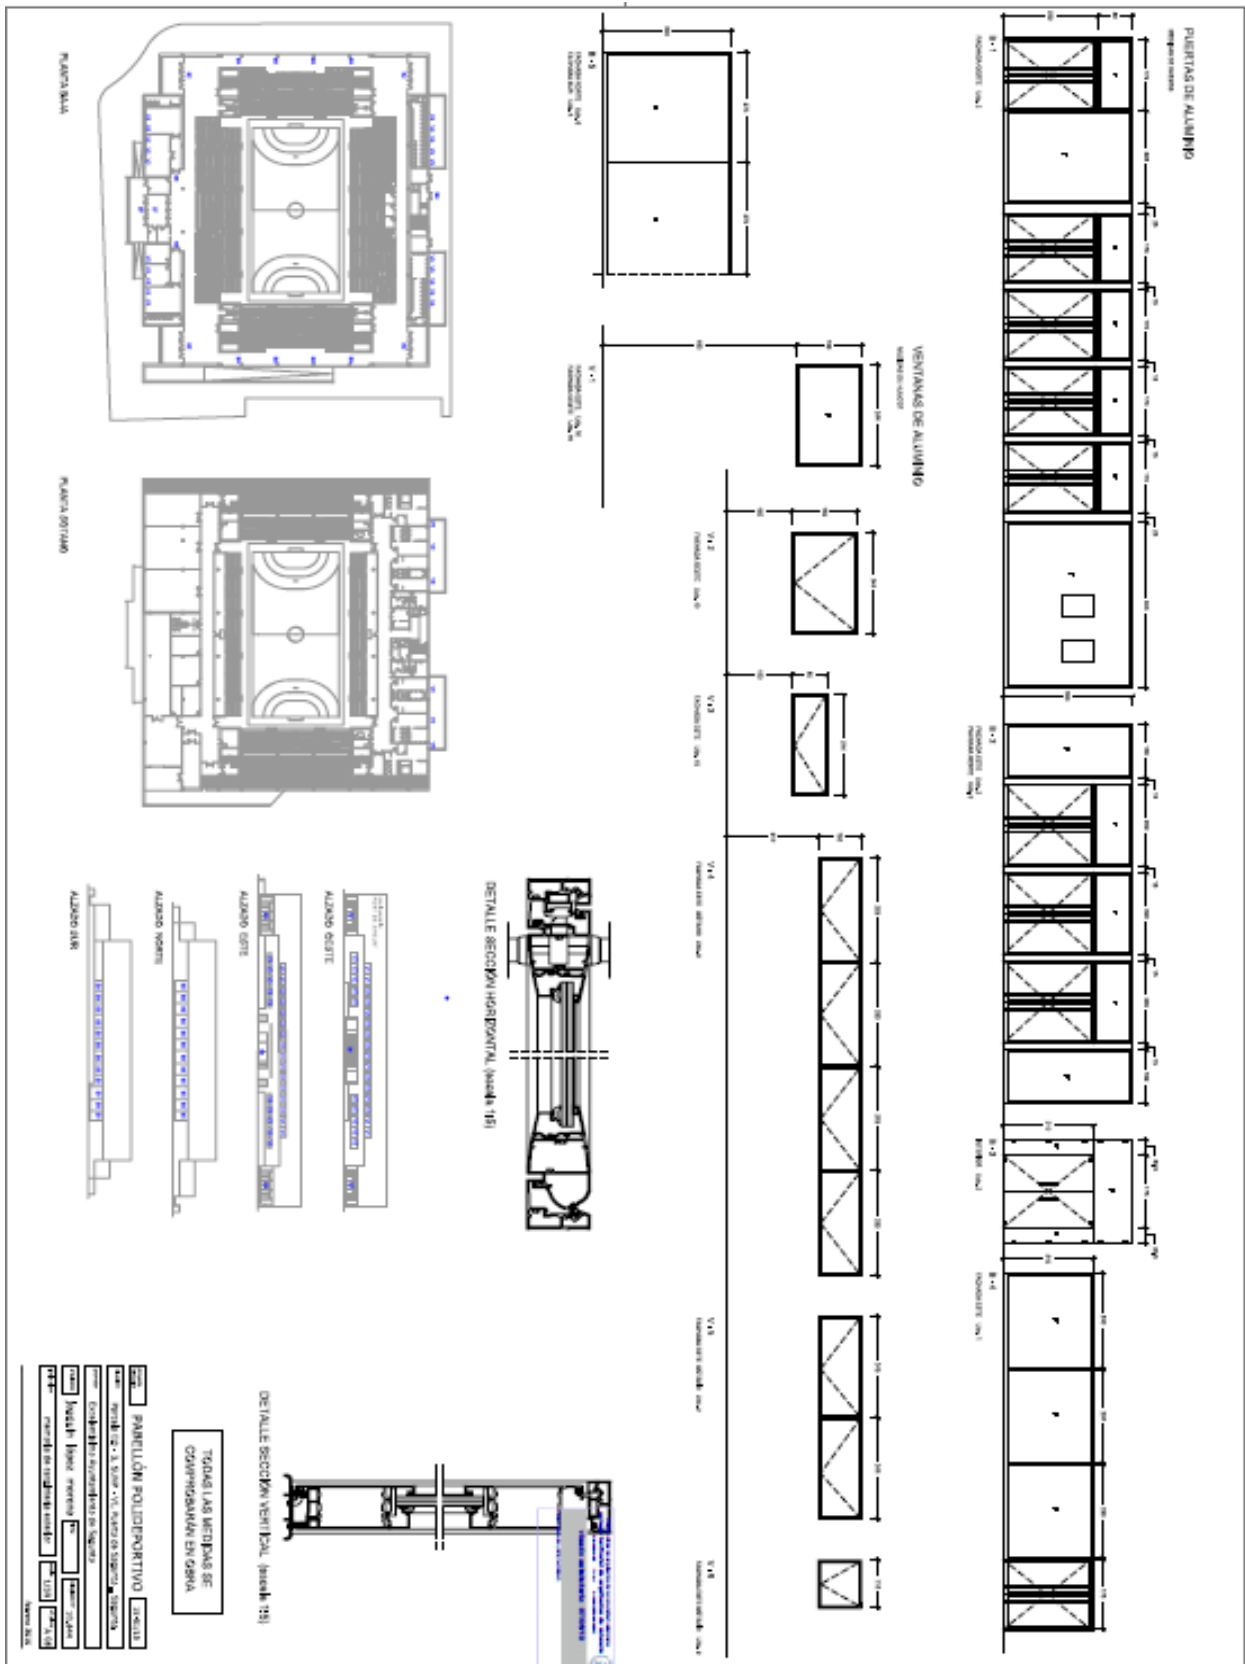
Plano carpintería. Fuente: Proyecto de Ejecución.
